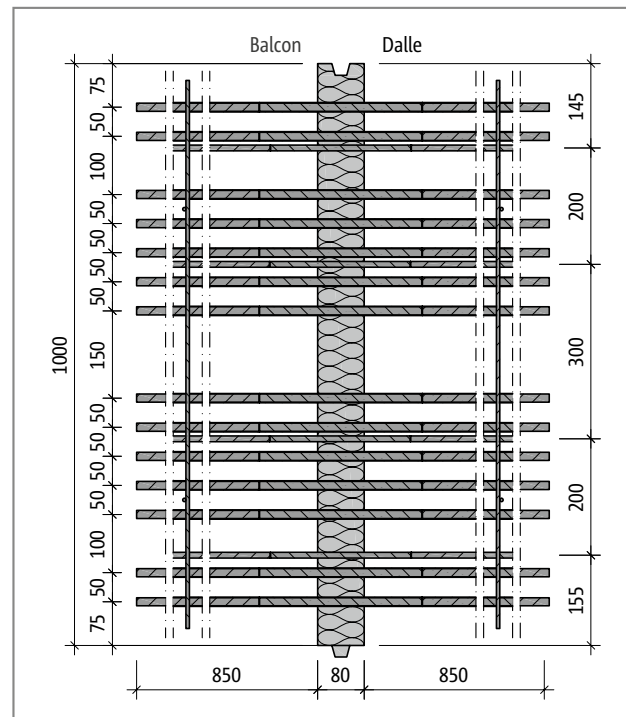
Schöck Isokorb® T Type K-M13-V1 : Plan de base du produit
